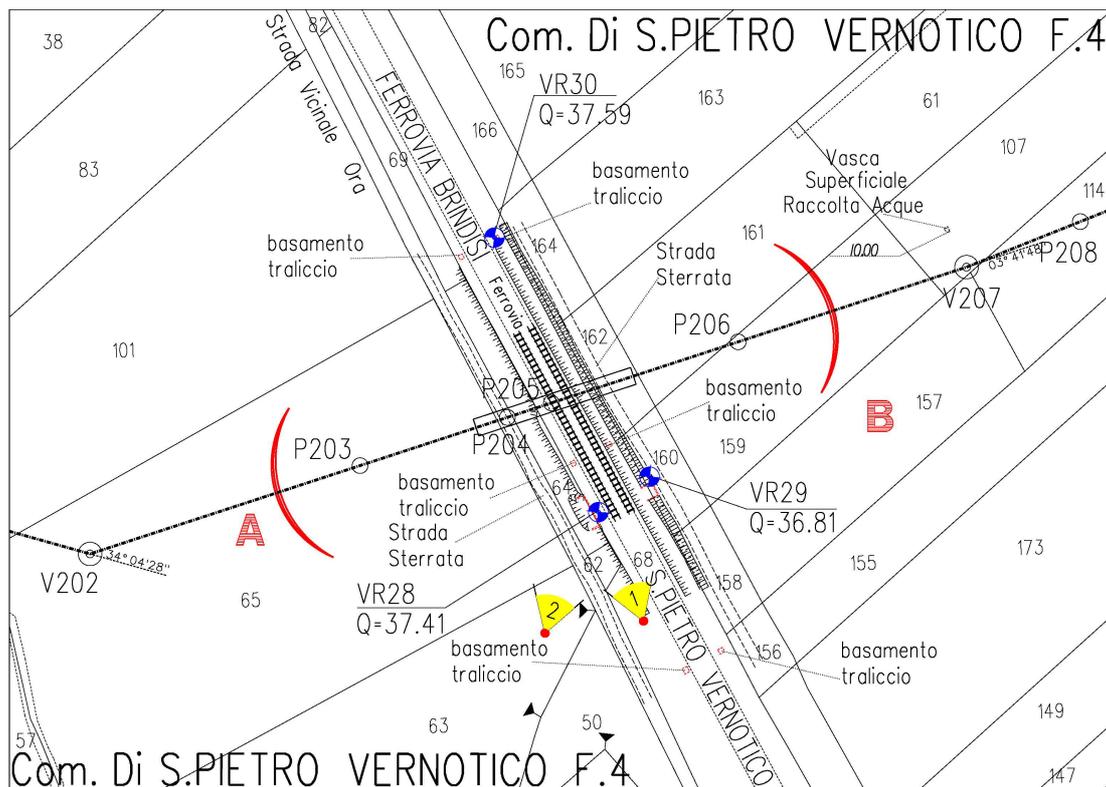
Stralcio catastale zona interessata dall'attraversamento in progetto
